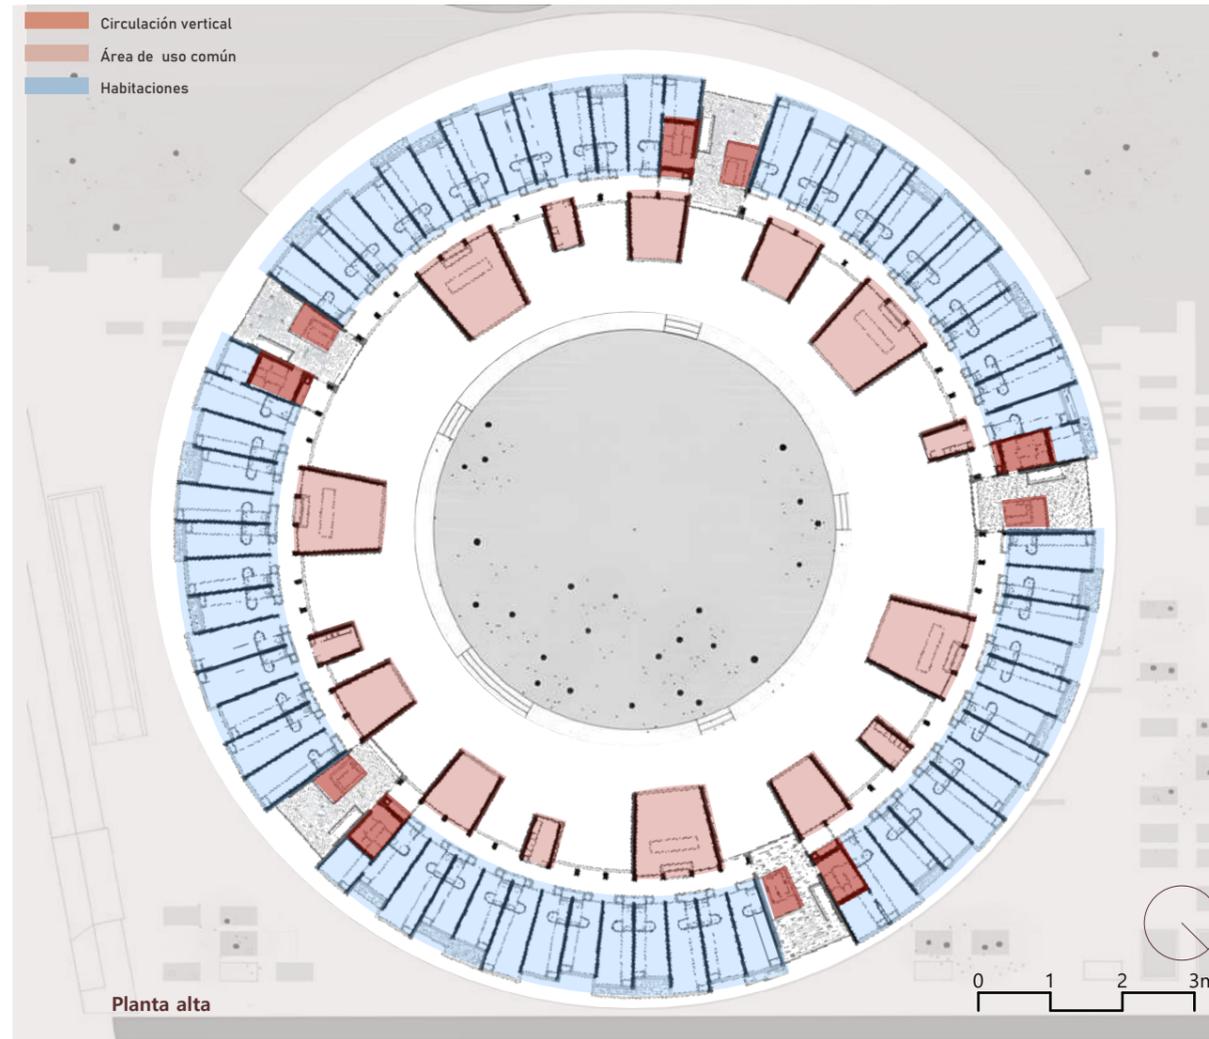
Planta esquemática edificio Tietgen Dormitory Fuente. Autoría Propia
